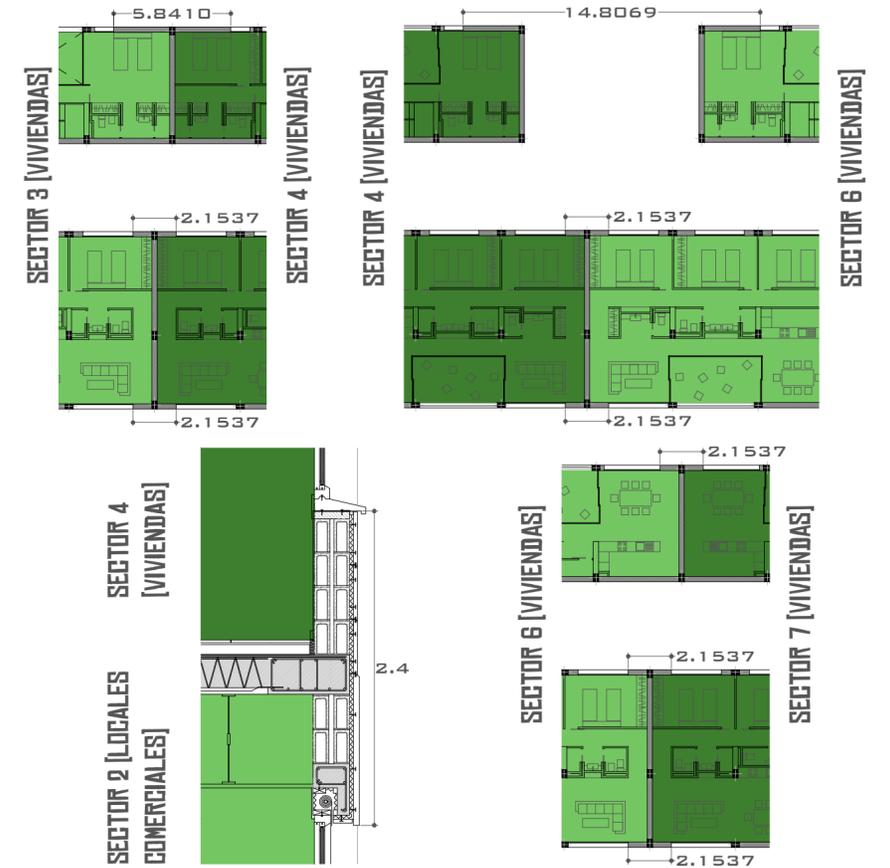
ENCUENTRO FORJADO-FACHADA
